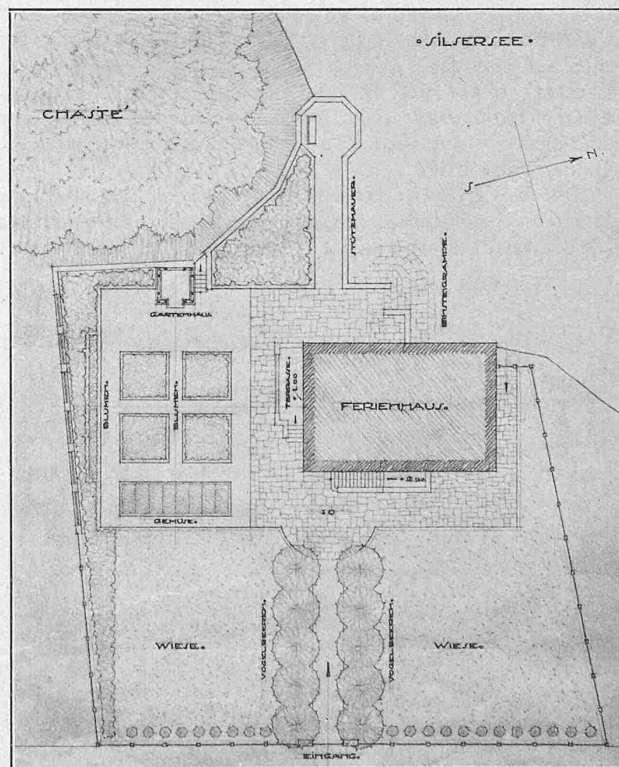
Ferienhaus Bartuns am Silsersee. — Lageplan 1:500.
